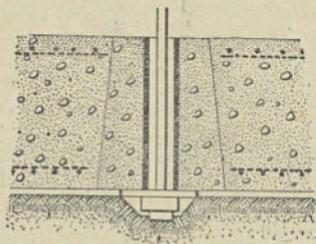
Trou dans la fondation pour le passage d'un boulon.
